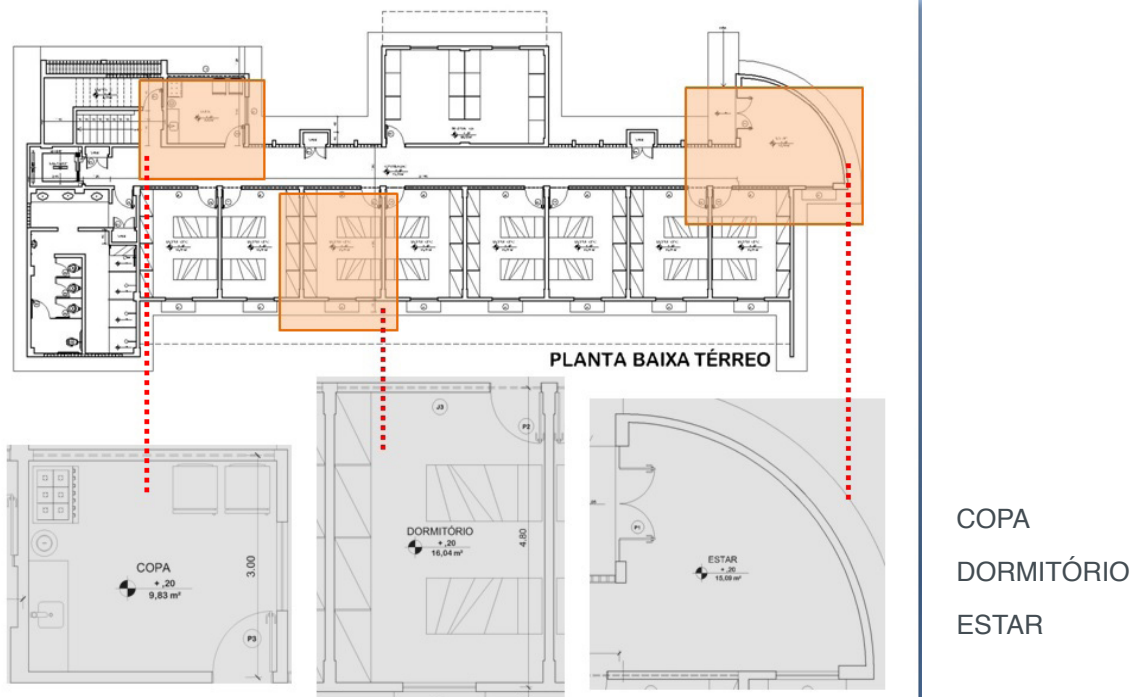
Planta baixa do projeto original para as residências Campus III (2011).
